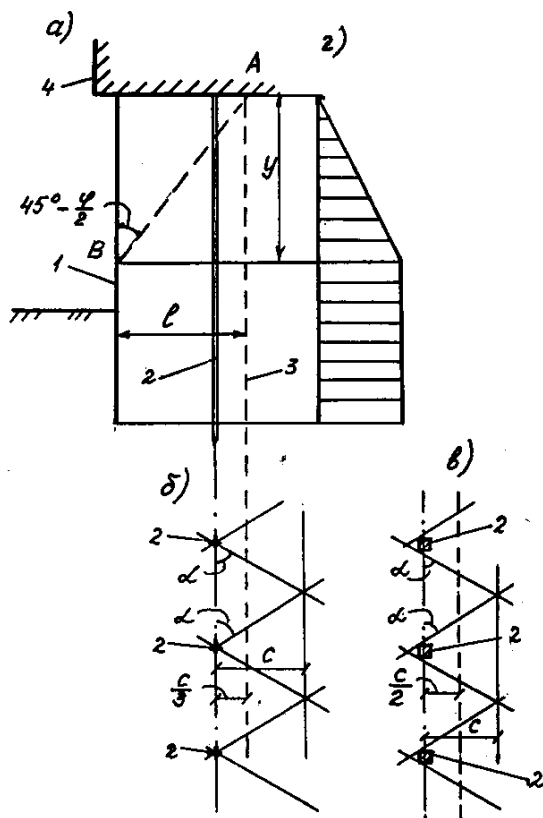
Схема к определению бокового давления грунта на переднюю шпунтовую стенку при вертикальном экранирующем свайном ряде:
